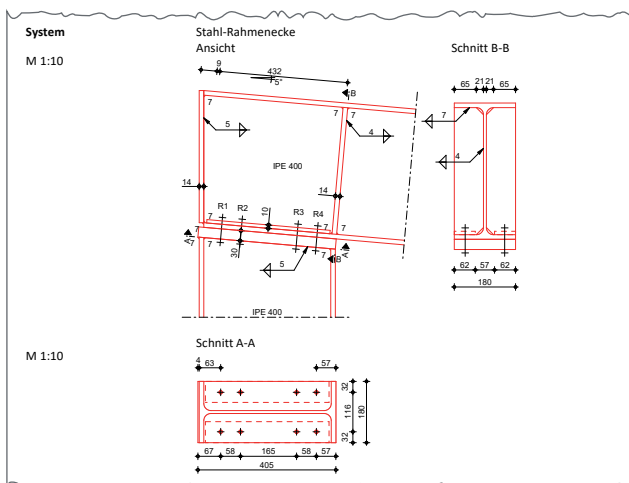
Stahlbau-Anschlussnachweise in der BauStatik
